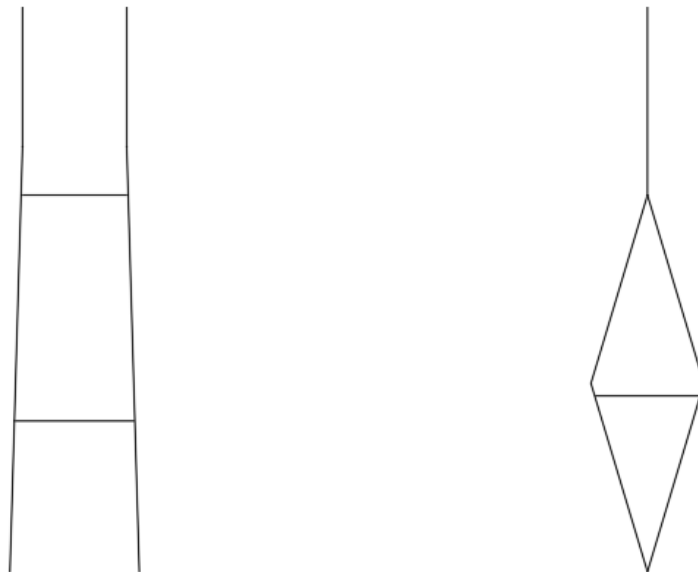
Geometría pilonos general según planos transversales de atirantamiento
